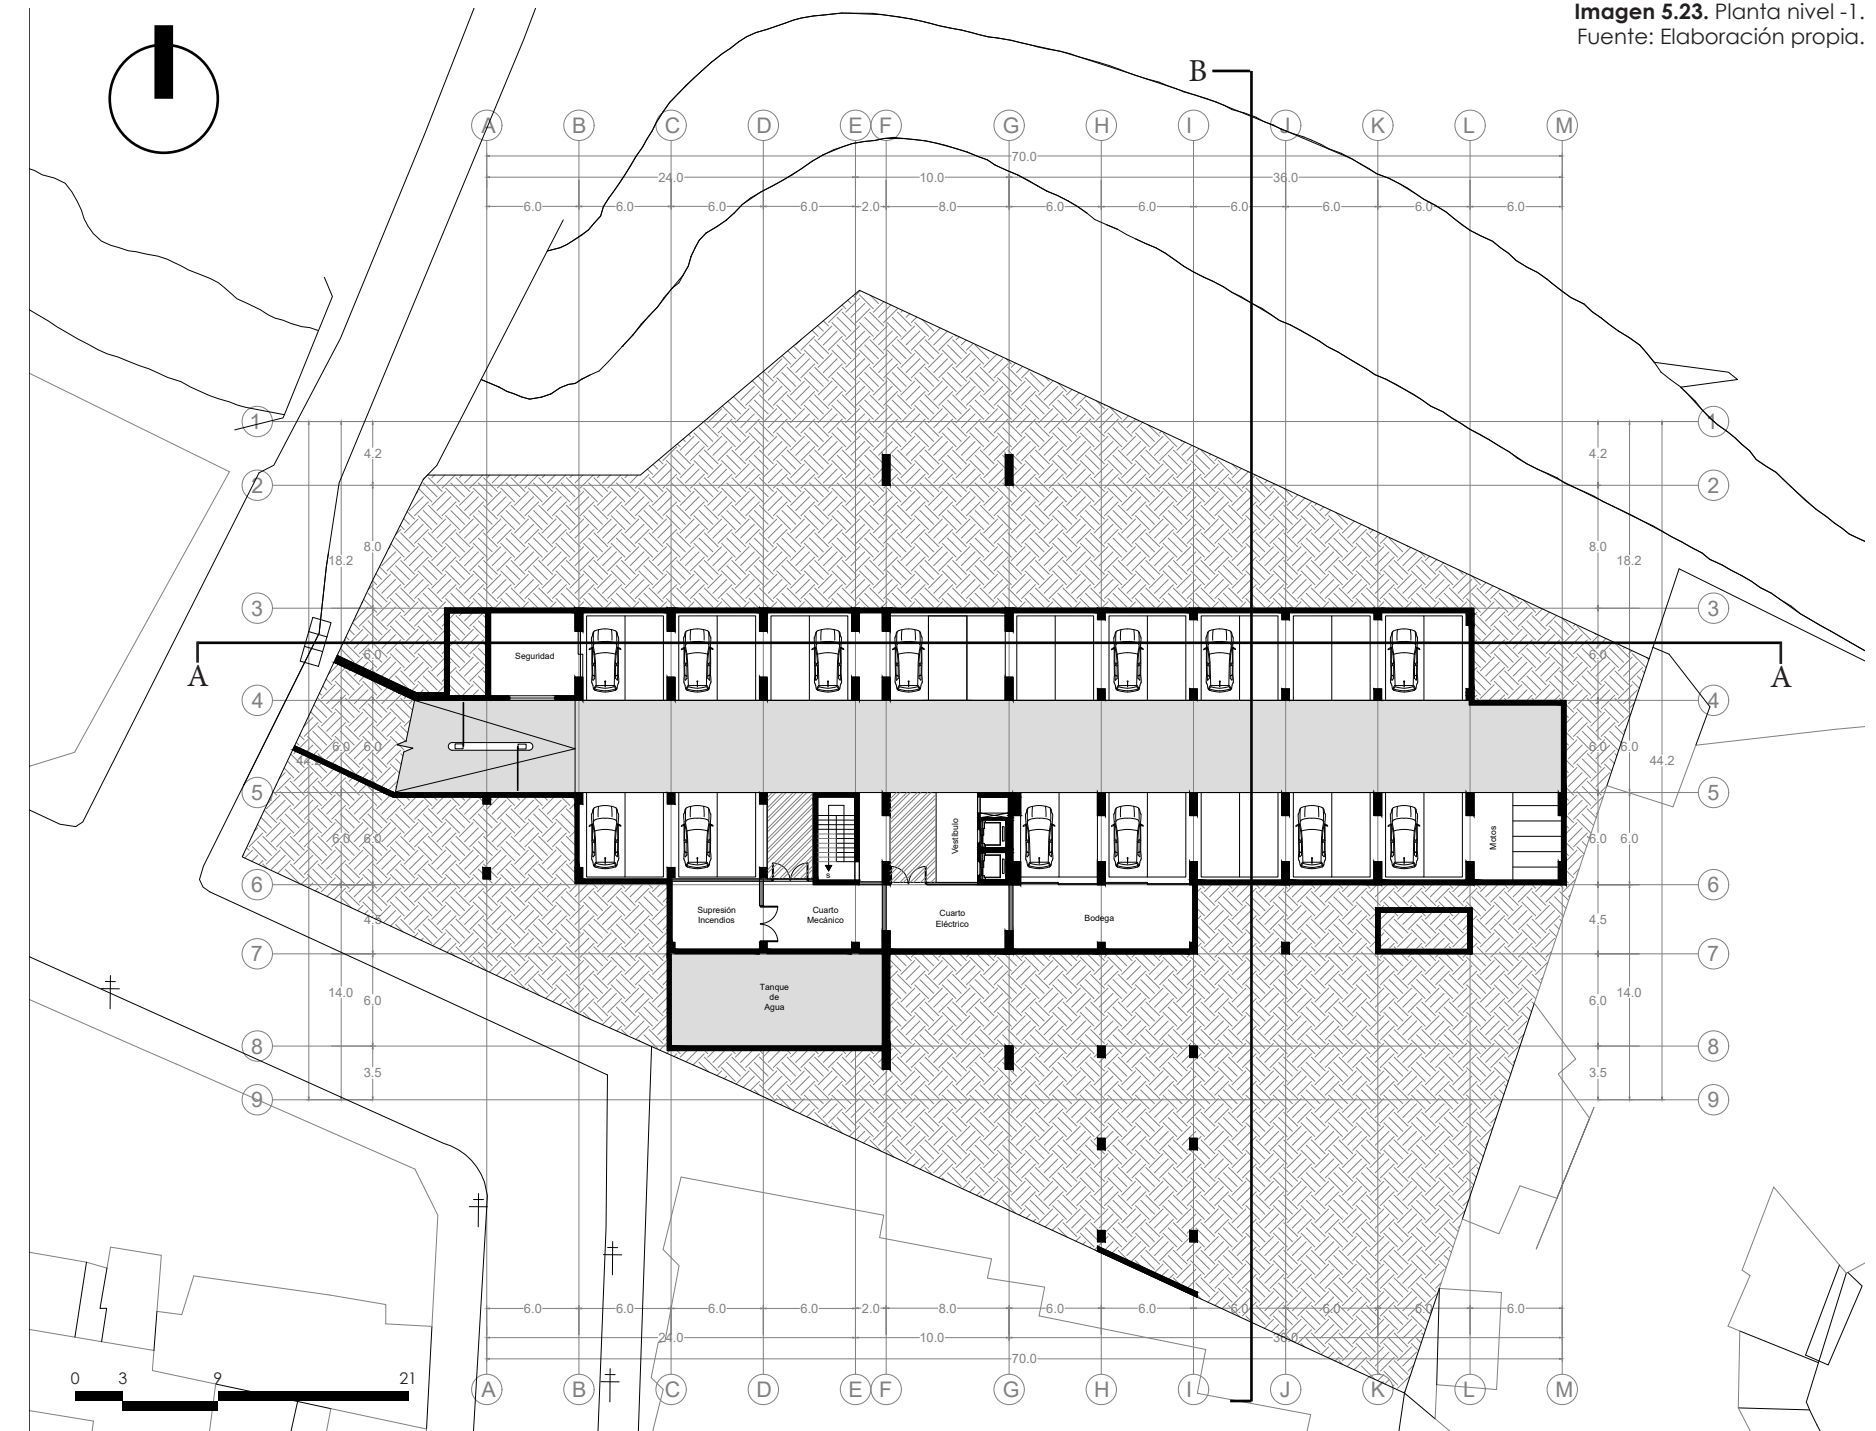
Planta nivel -1. Fuente: Elaboración propia.
